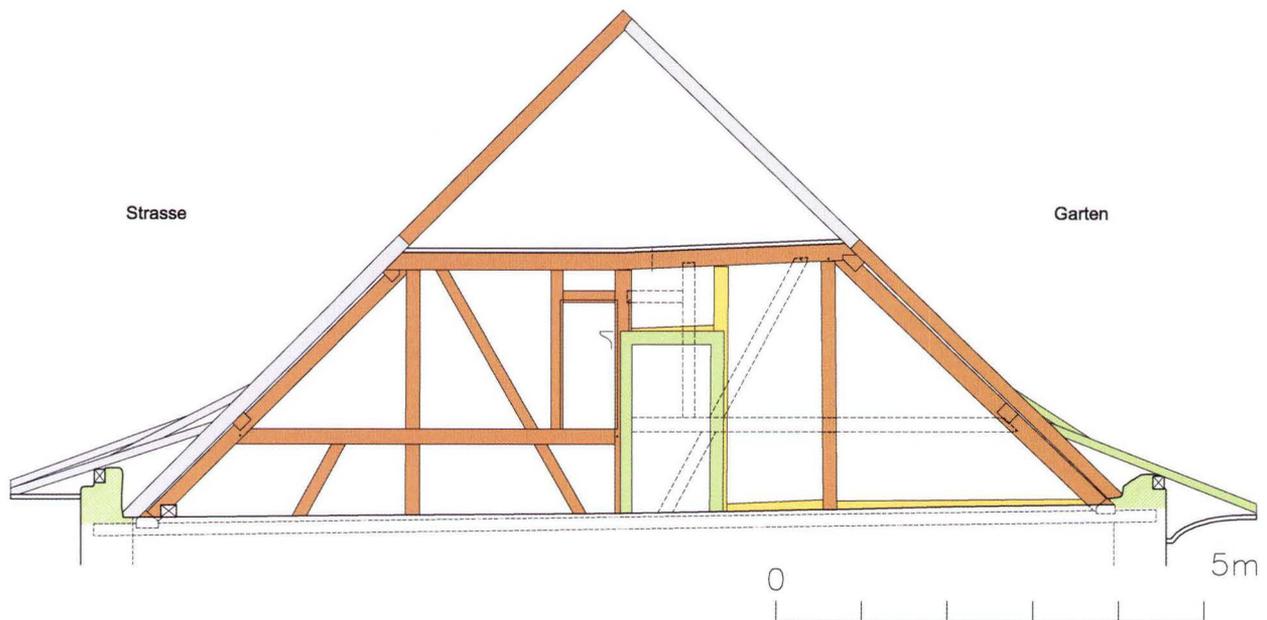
Hebelstrasse 7. Teil B, Dachgeschoss. Ansicht der westlichen Giebelwand des Hauses A (einstige Aussenseite). Das äusserste Gebinde des Dachstuhls (1576/77) bildet den Rahmen des Fachwerks (braun). Die Wand hatte eine symmetrisch angelegte Einteilung mit zwei kleinen Fenstern in der Mitte (Rekonstruktion). Bei der späteren Erweiterung des Gebäudes um 1603/04 wurden Teile der Konstruktion entfernt und eine Türöffnung angelegt (gelb; Türrahmen sekundär). Die Traufe wurde 1757/58 in den Gebäudeabschnitten A und B erhöht (grün, siehe Erweiterung C); Teile des Dachwerks wurden im 20. Jahrhundert erneuert (grau). – Zeichnung: Jukka Altermatt und Benjamin Fischer.
